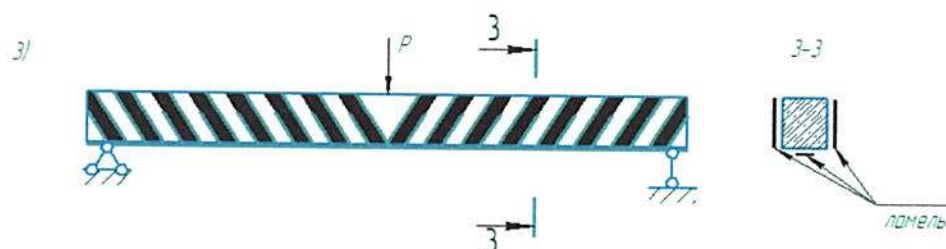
Испытание перемычек с усилением ламелями по нормальным и наклонным сечениям. Серия ПуІІІ
